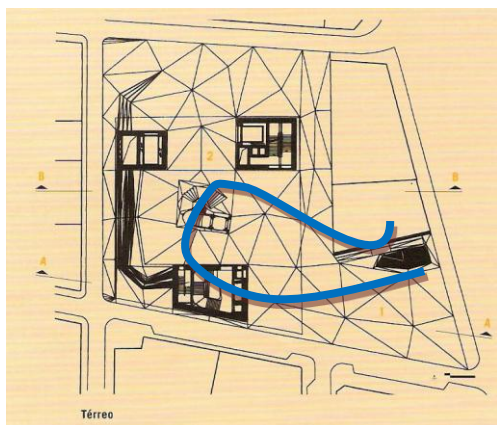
imagem planta baixa do primeiro piso do Fórum de Madri .
